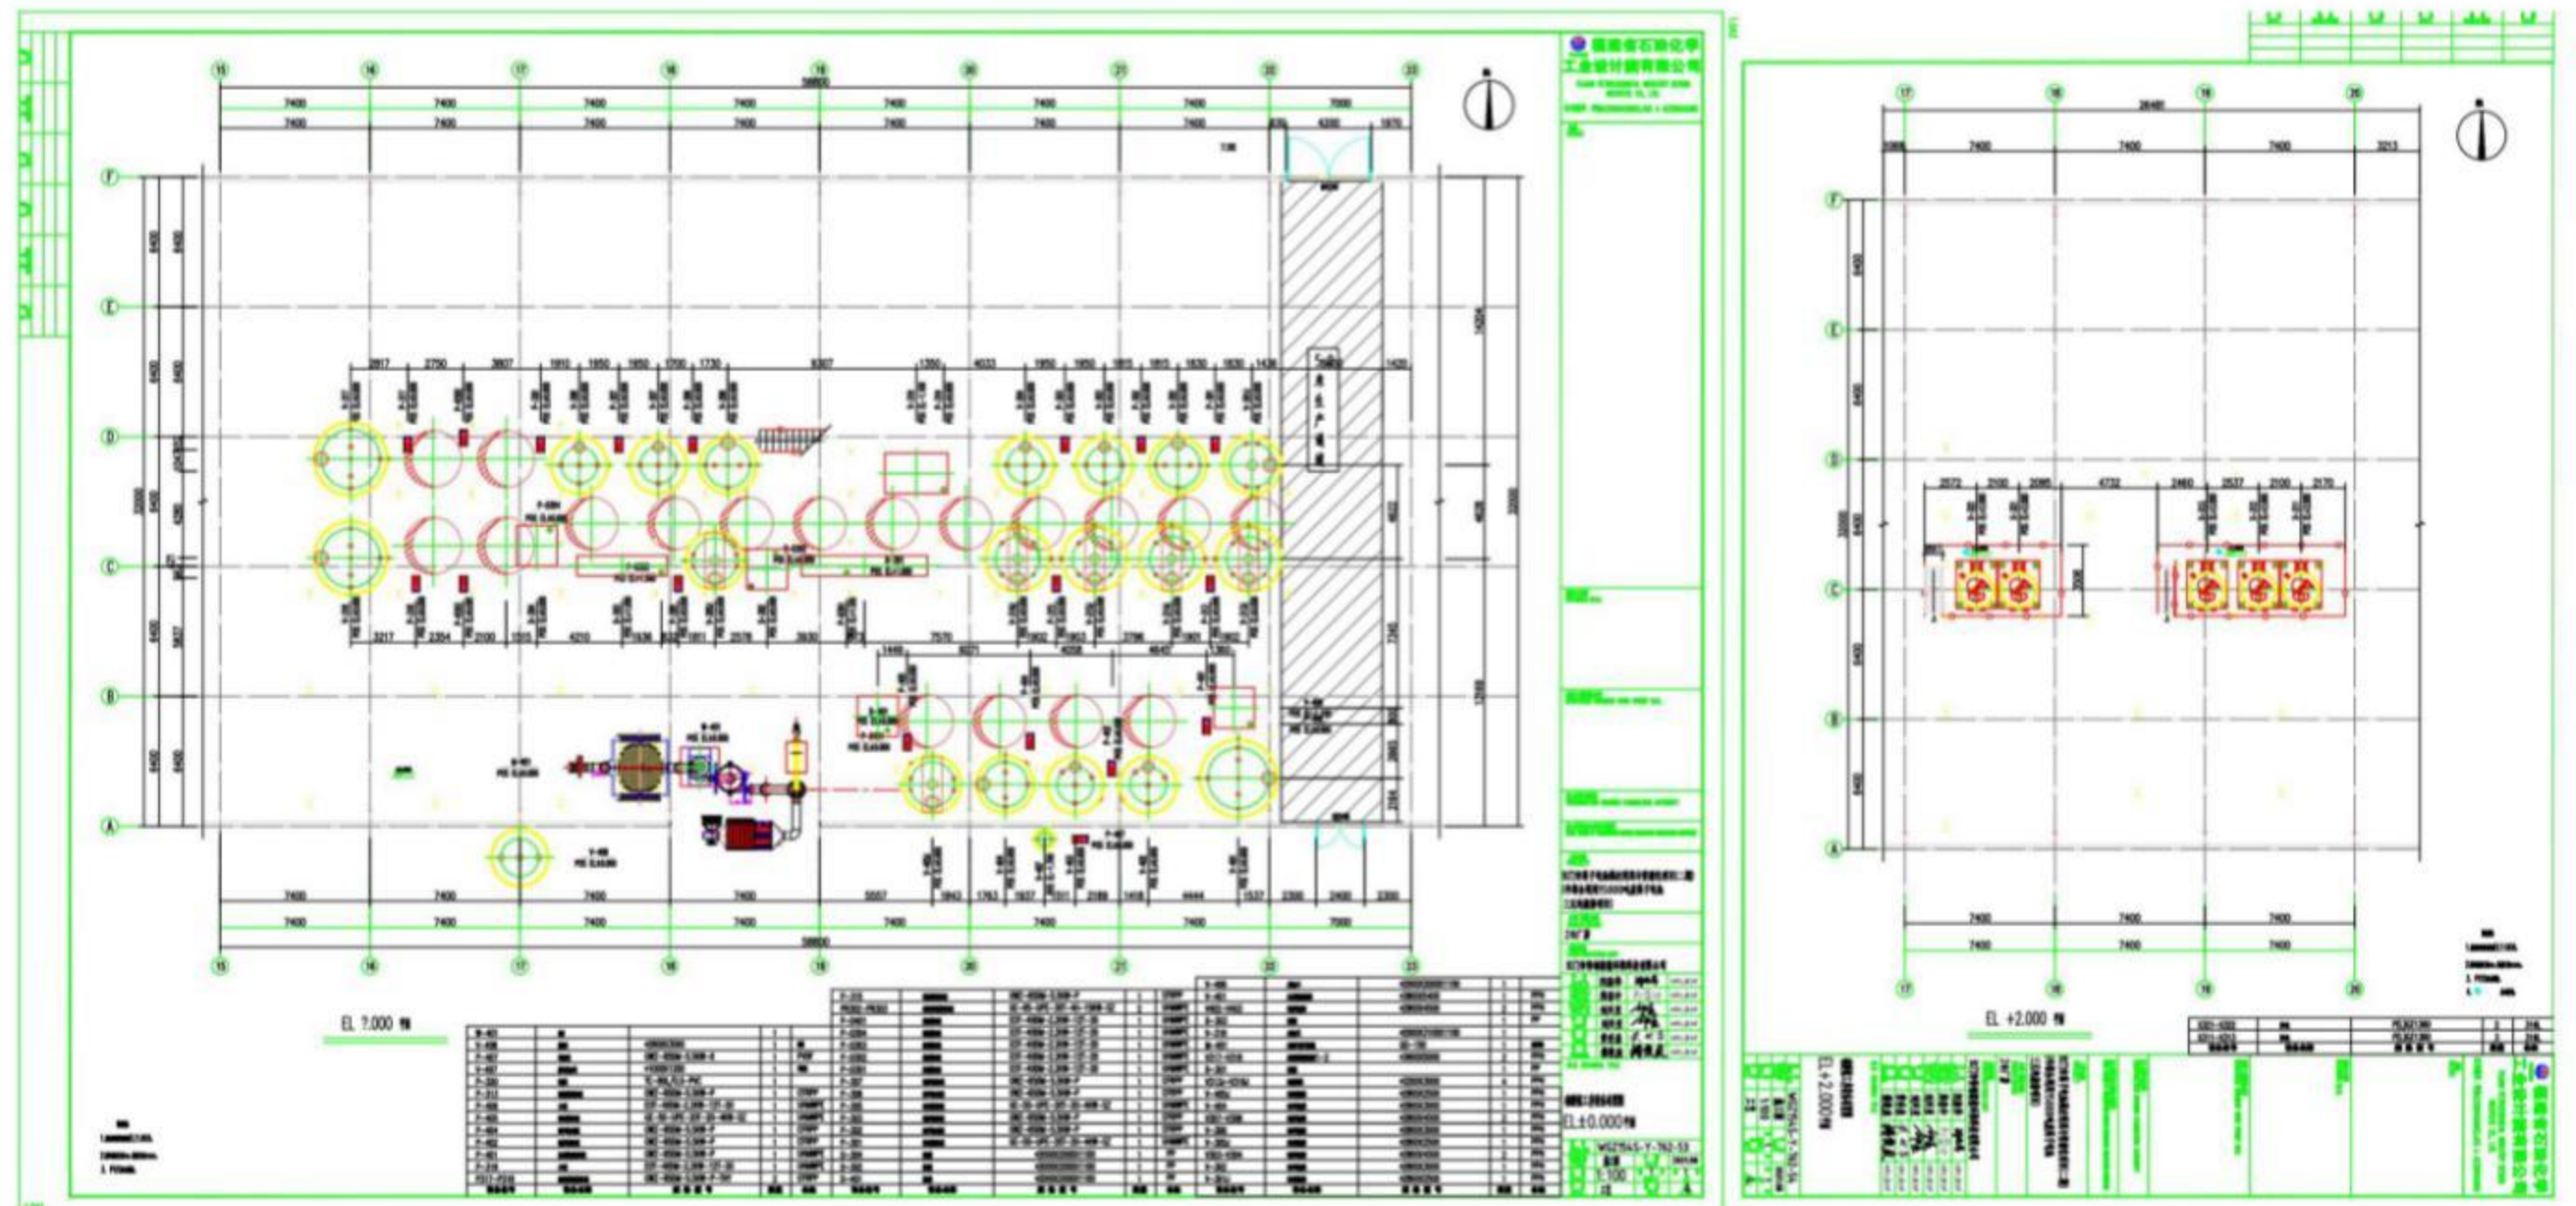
2#厂房-硫酸锰区域(0.00,2.00)平面布置图
